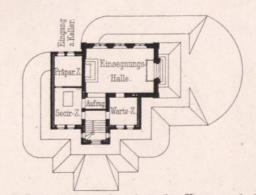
Leichenhaus. Grundrifs des Hauptgeschofses.
